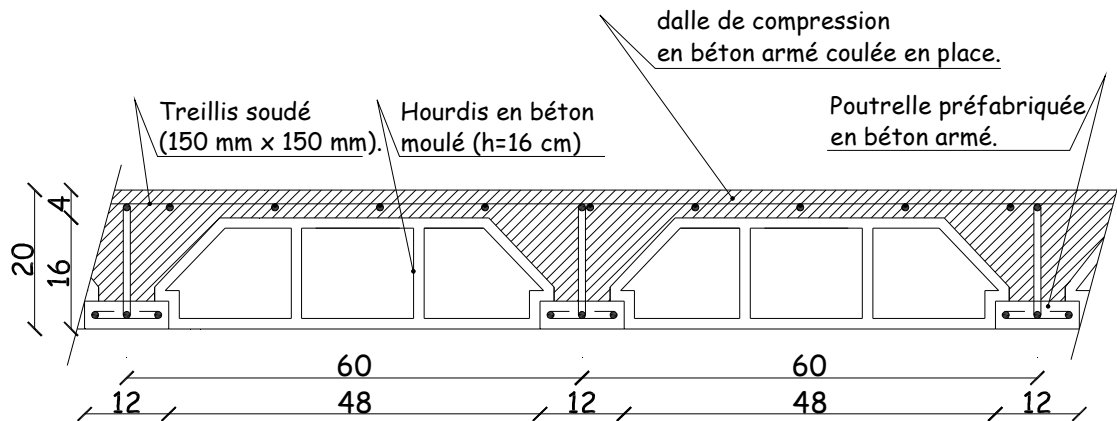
Plancher en béton armé avec poutrelles et hourdis (Plancher semi-préfabriqué)
